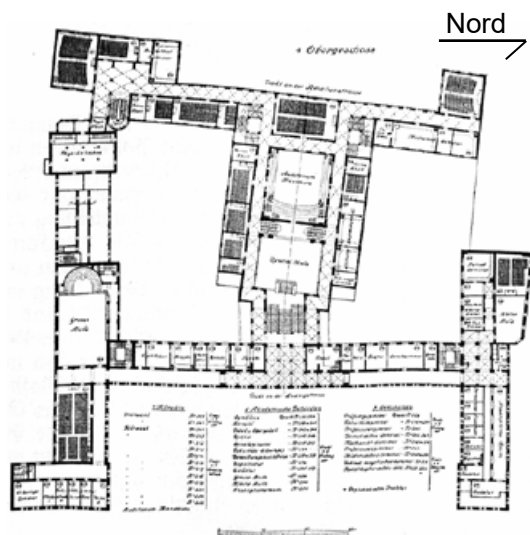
Gesamtgrundriss (BAI 1912, S. 508).
